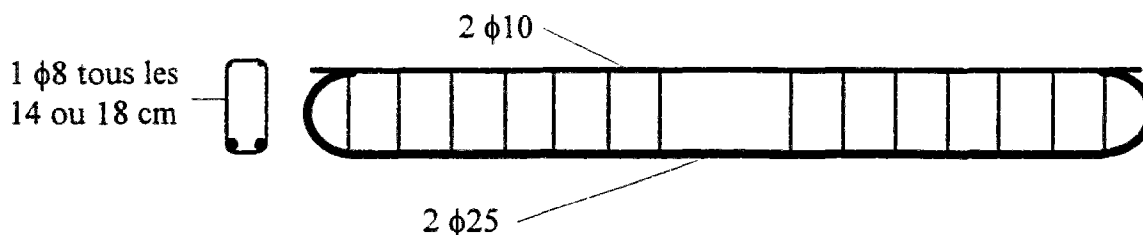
Ferrailage des poutrelles rectangulaires.
